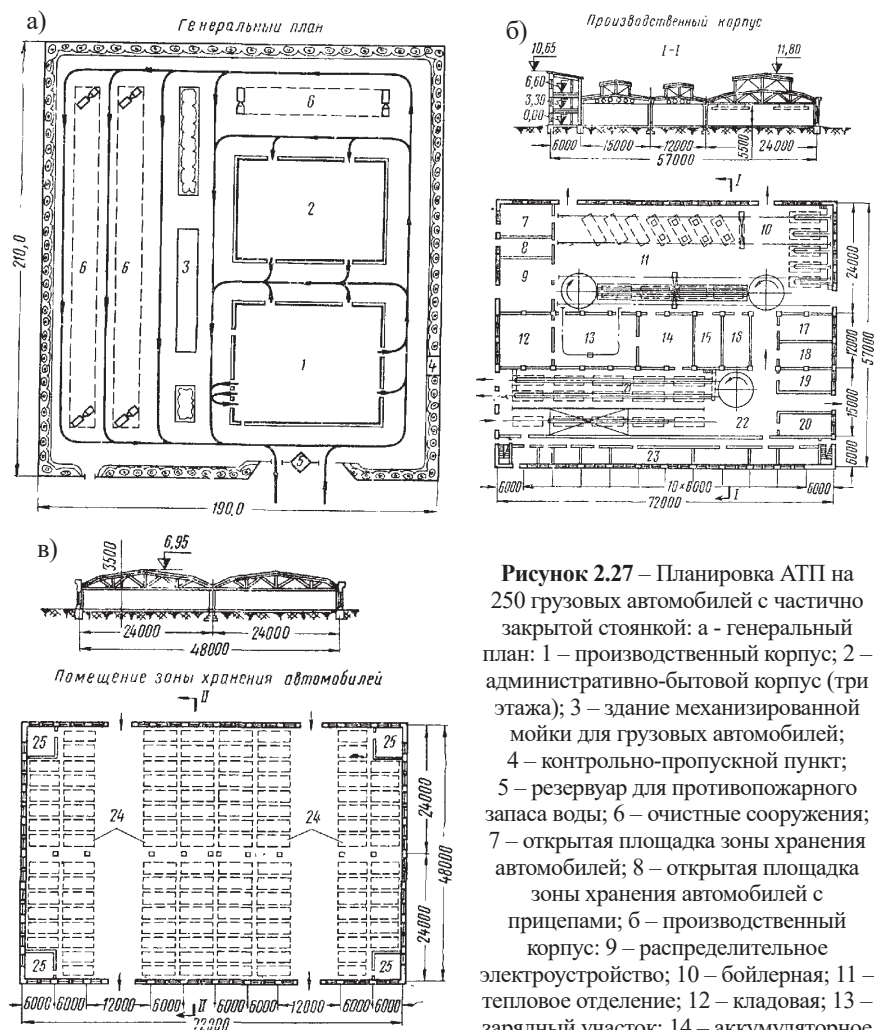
Планировка АТП на 250 грузовых автомобилей с частично закрытой стоянкой: а - генеральный план: 1 – производственный корпус; 2 – административно-бытовой корпус (три этажа); 3 – здание механизированной мойки для грузовых автомобилей; 4 – контрольно-пропускной пункт; 5 – резервуар для противопожарного запаса воды; 6 – очистные сооружения; 7 – открытая площадка зоны хранения автомобилей; 8 – открытая площадка зоны хранения автомобилей с прицепами; б – производственный корпус: 9 – распределительное электроустройство; 10 – бойлерная; 11 – тепловое отделение; 12 – кладовая; 13 – зарядный участок; 14 – аккумуляторное
